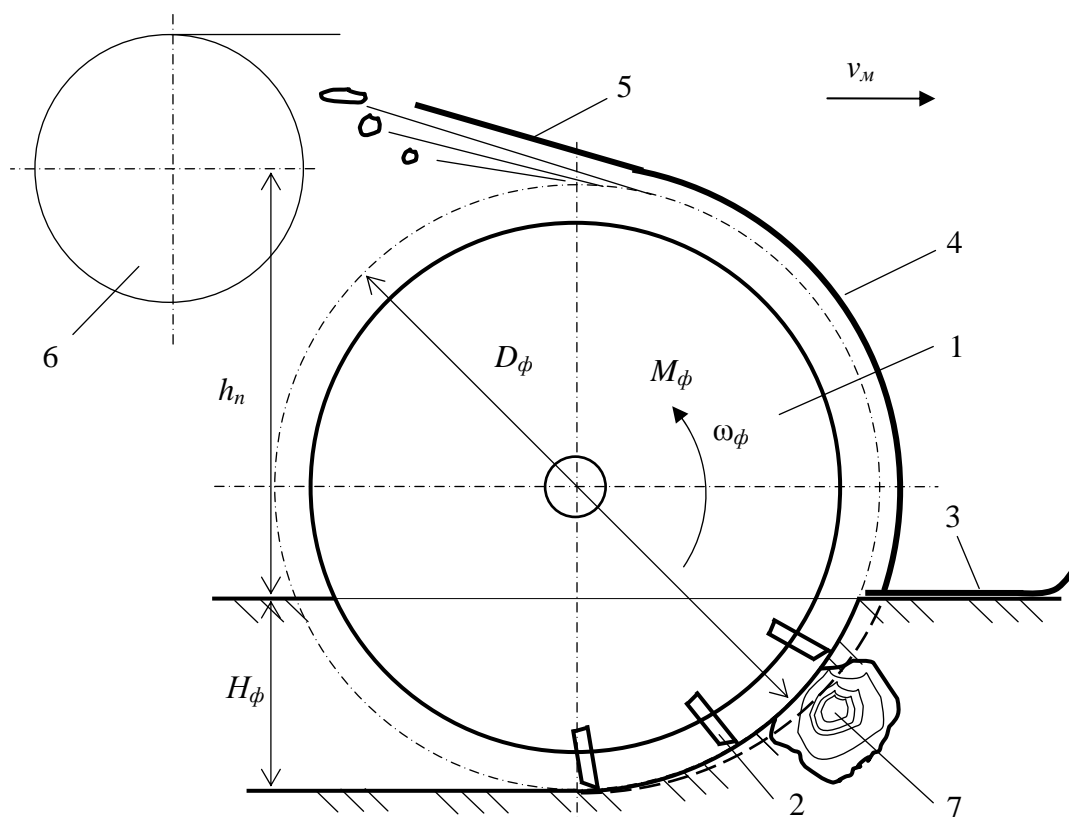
Схема фрезерования торфяной залежи дисковой фрезой:
